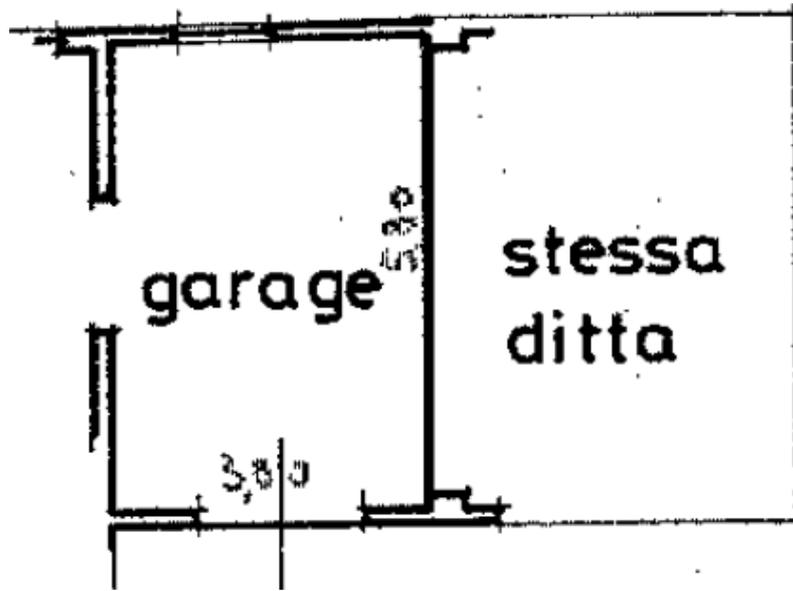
Estratto della planimetria catastale – sub. 2, p.t.
